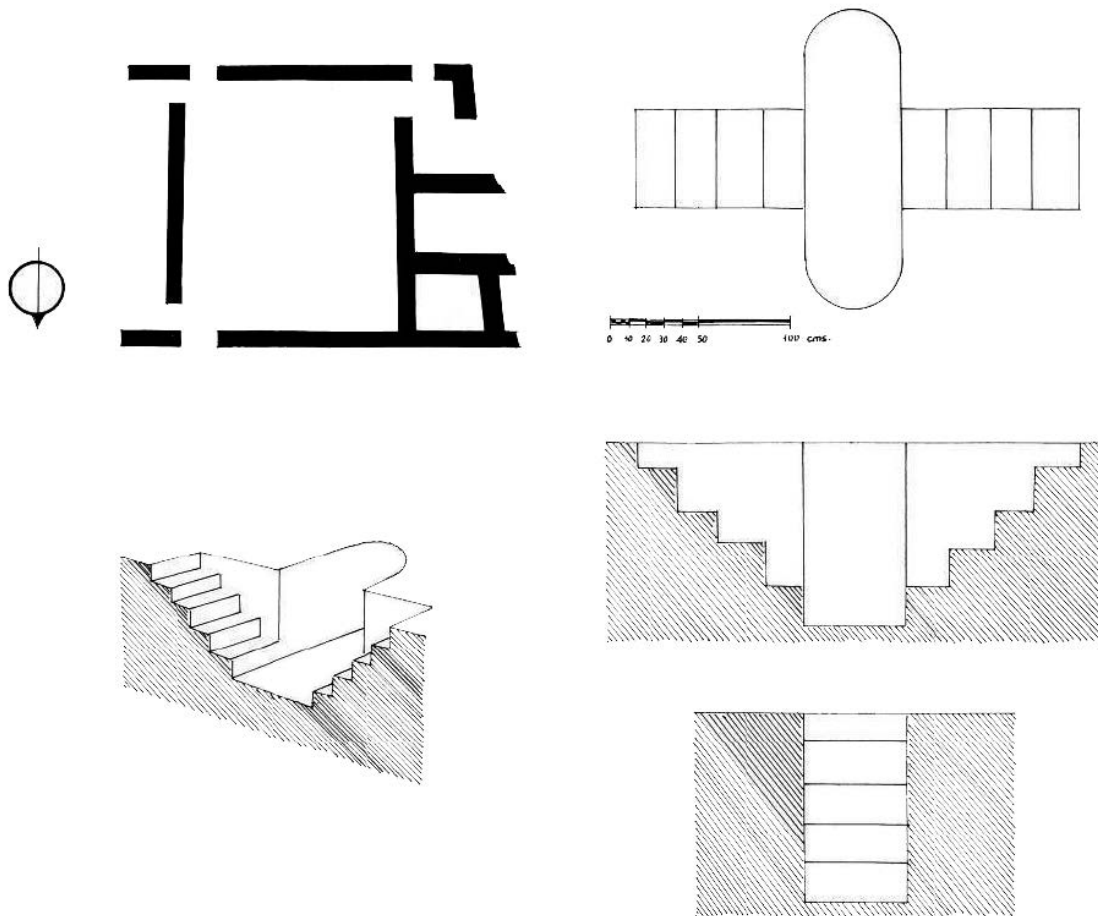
Dibujo esquemático de la planta del baptisterio de Son Peretó, y planta, alzado y secciones de su piscina bautismal mayor (Iturgaiz 1963)
